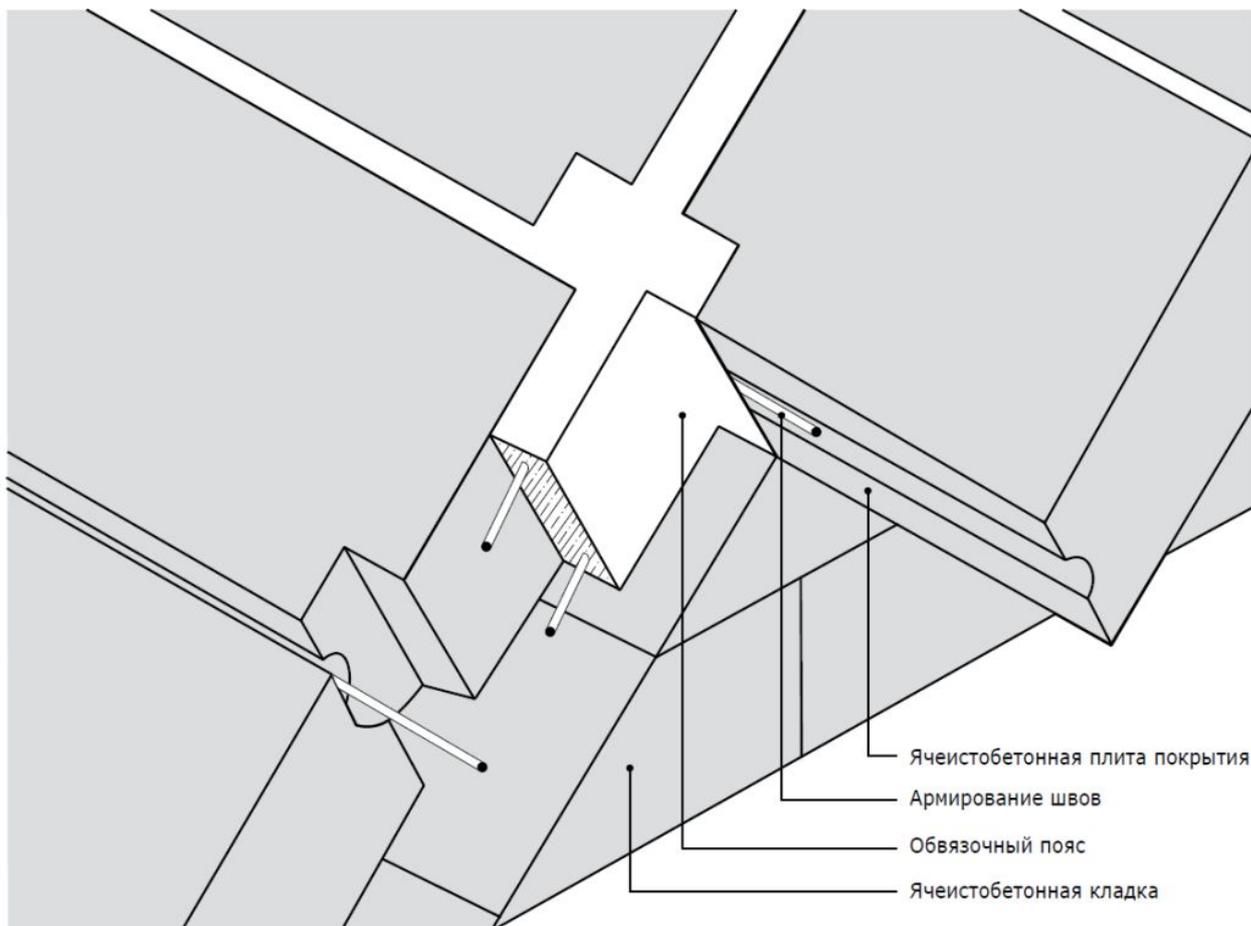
Зона сопряжения стена-покрытие. Двустороннее опирание панелей покрытия на кладку фронтона, обвязочный пояс со шпонками в уровне панелей
